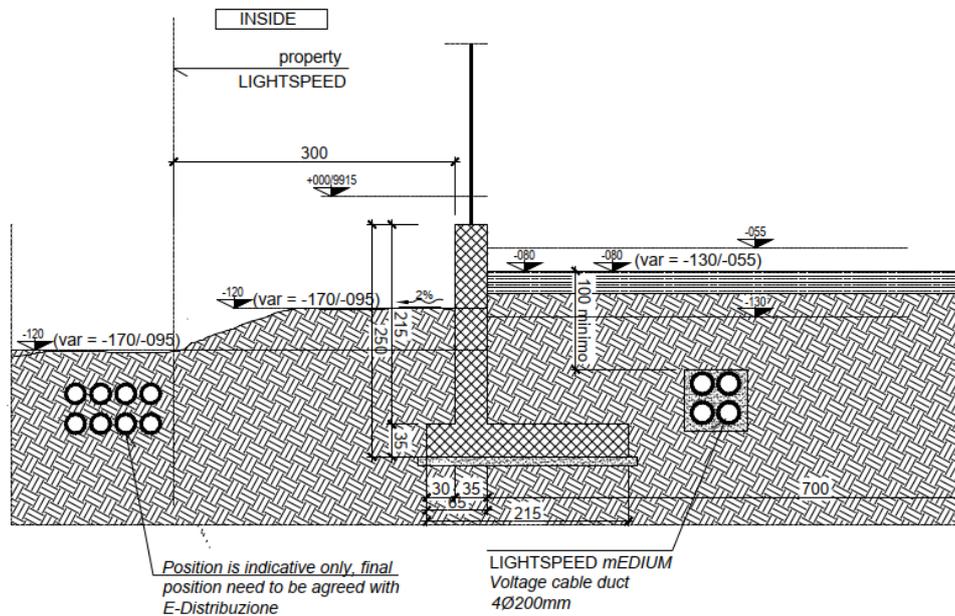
Prospetto servizi adiacenti recinzione lato Ovest
